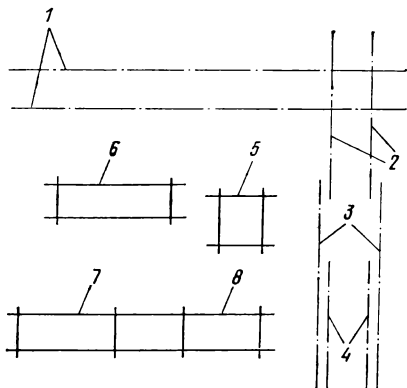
Разбивочные оси на строительной площадке КБСГ
